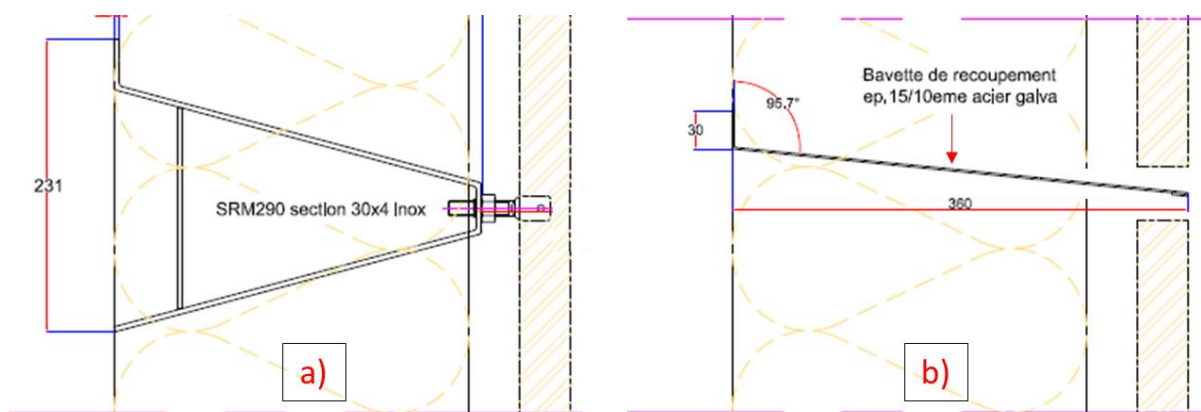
coupe de principe pour illustrer : a) le système d'attaches entre les plaques en pierre naturelle et la façade support béton ; b) la bavette de recouvrement non débordante
